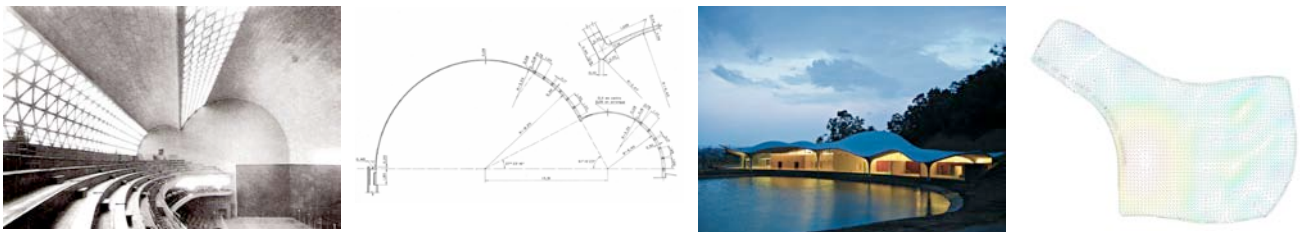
Frontón de Recoletos: (1) vista interior del edificio y (2) sección transversal tipo de la cubierta. Crematorio en Gifu: (3) vista exterior del edificio y (4) modelo de elementos finitos.
